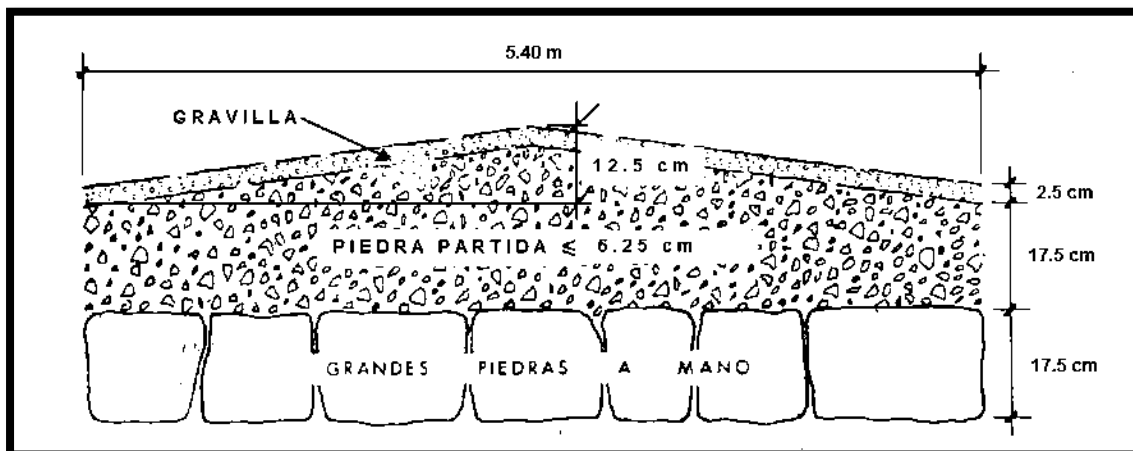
Sección de pavimento desarrollada por Thomas Telford, (fuente: Zorio, 1987).
